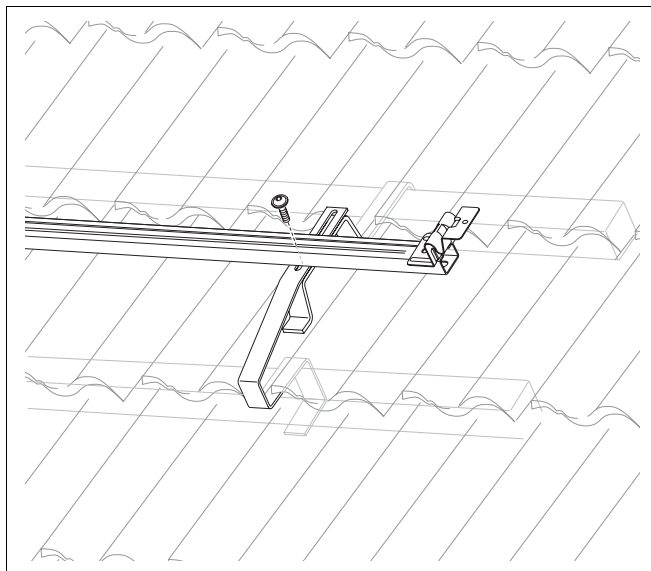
Atornillar los perfiles guía montados previamente con el gancho de tejado y su complemento
